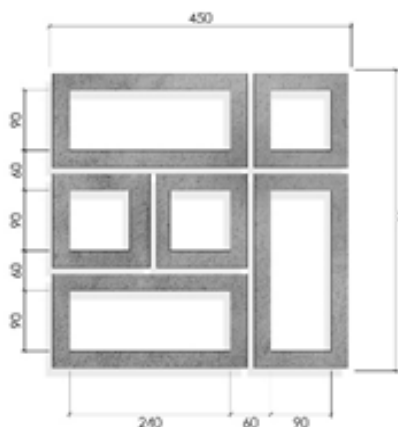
Detalle de módulo y cada unidad, en hormigón prefabricado
